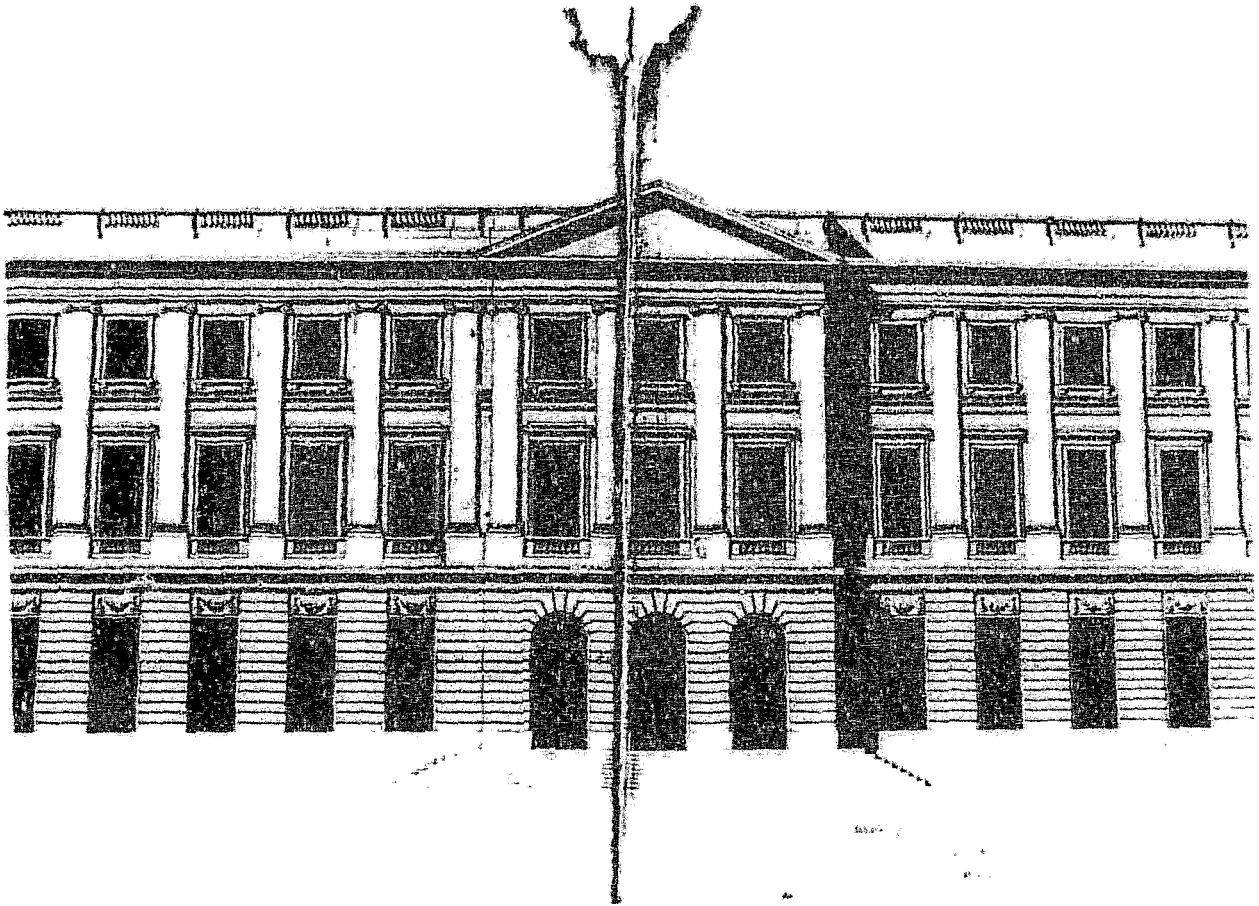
Palais Rohan .Elévation de la façade sur jardin . Bonfin 1778.
